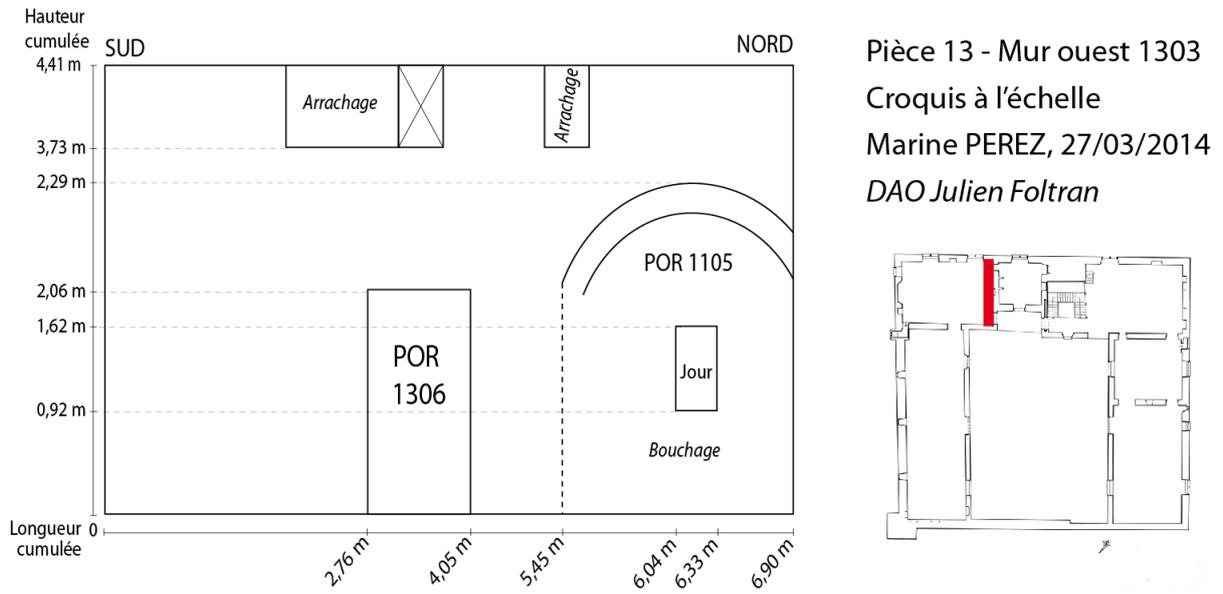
Mur ouest (1303) de la pièce sud-est au rez-de-chaussée (PCE 13), croquis.
